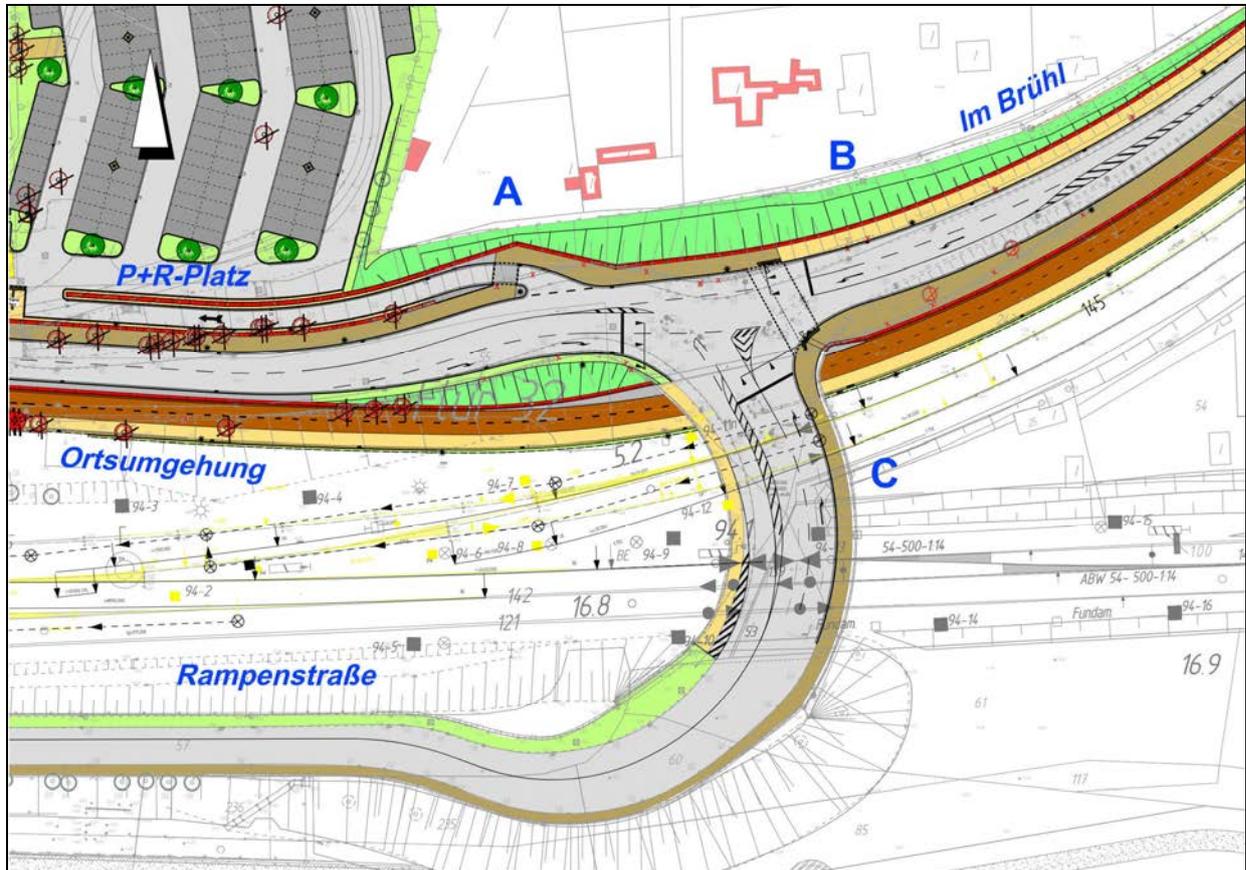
Knotenpunkt Im Brühl/Rampenstraße
